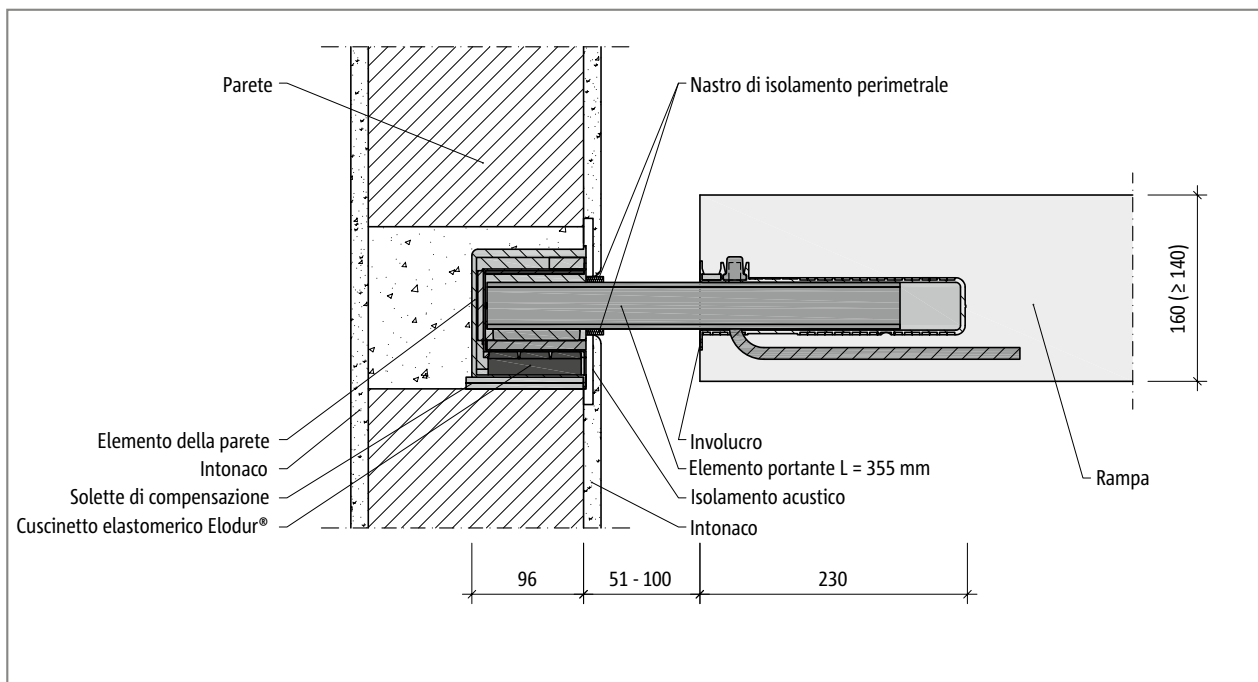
Schöck Tronsole® tipo Q-FV-XL o Q-A2-XL: sezione costruttiva - costruzione prefabbricata
